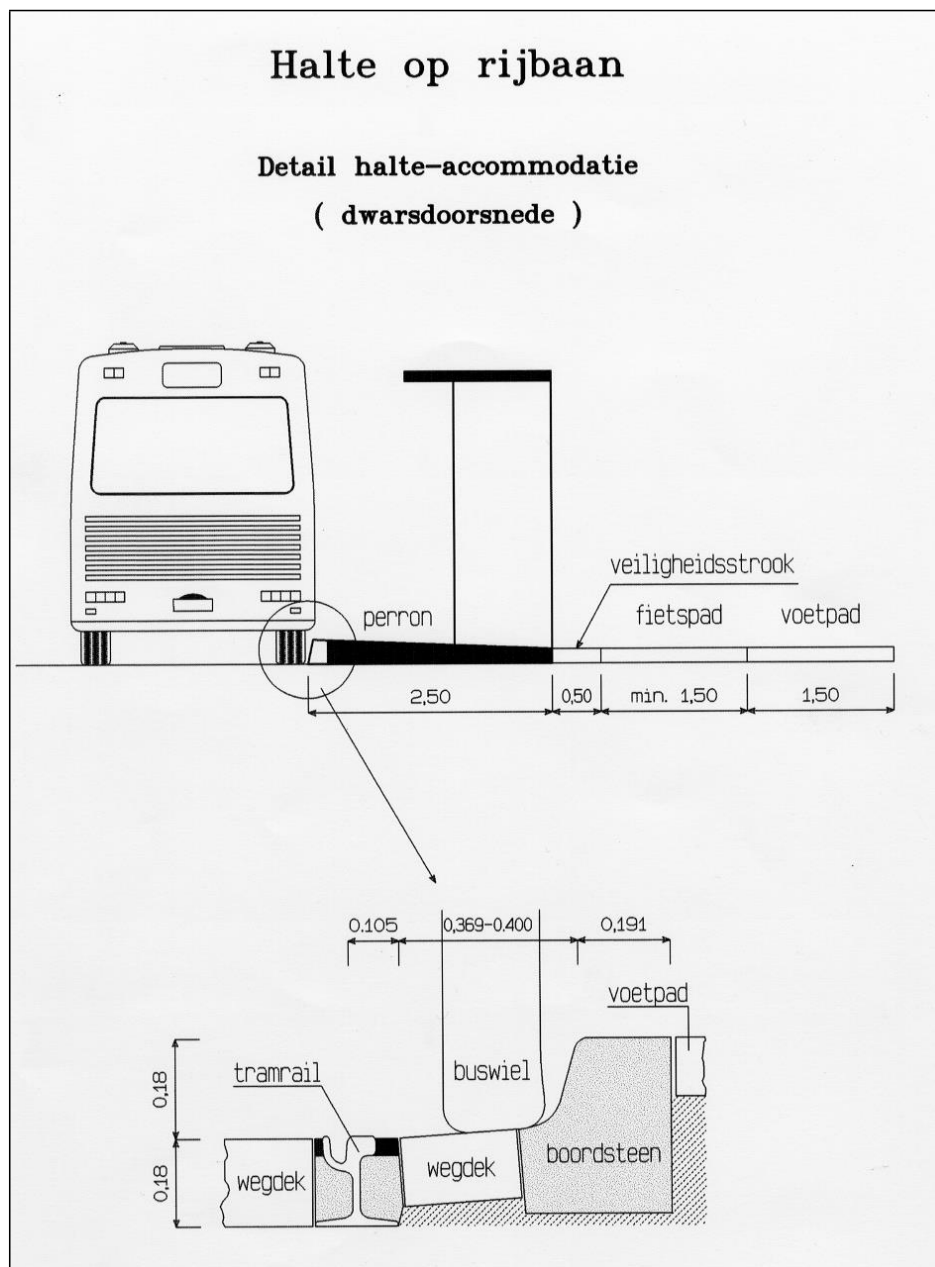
Halte op rijbaan. Halteaccommodatie met fietspad zonder parkeerstrook
